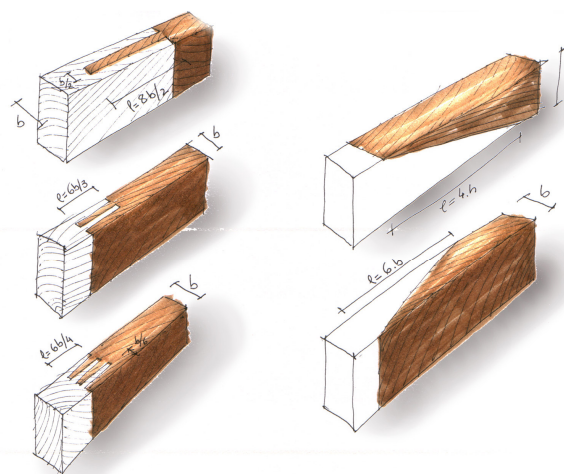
Consolidação de madeira utilizando uniões entalhadas
